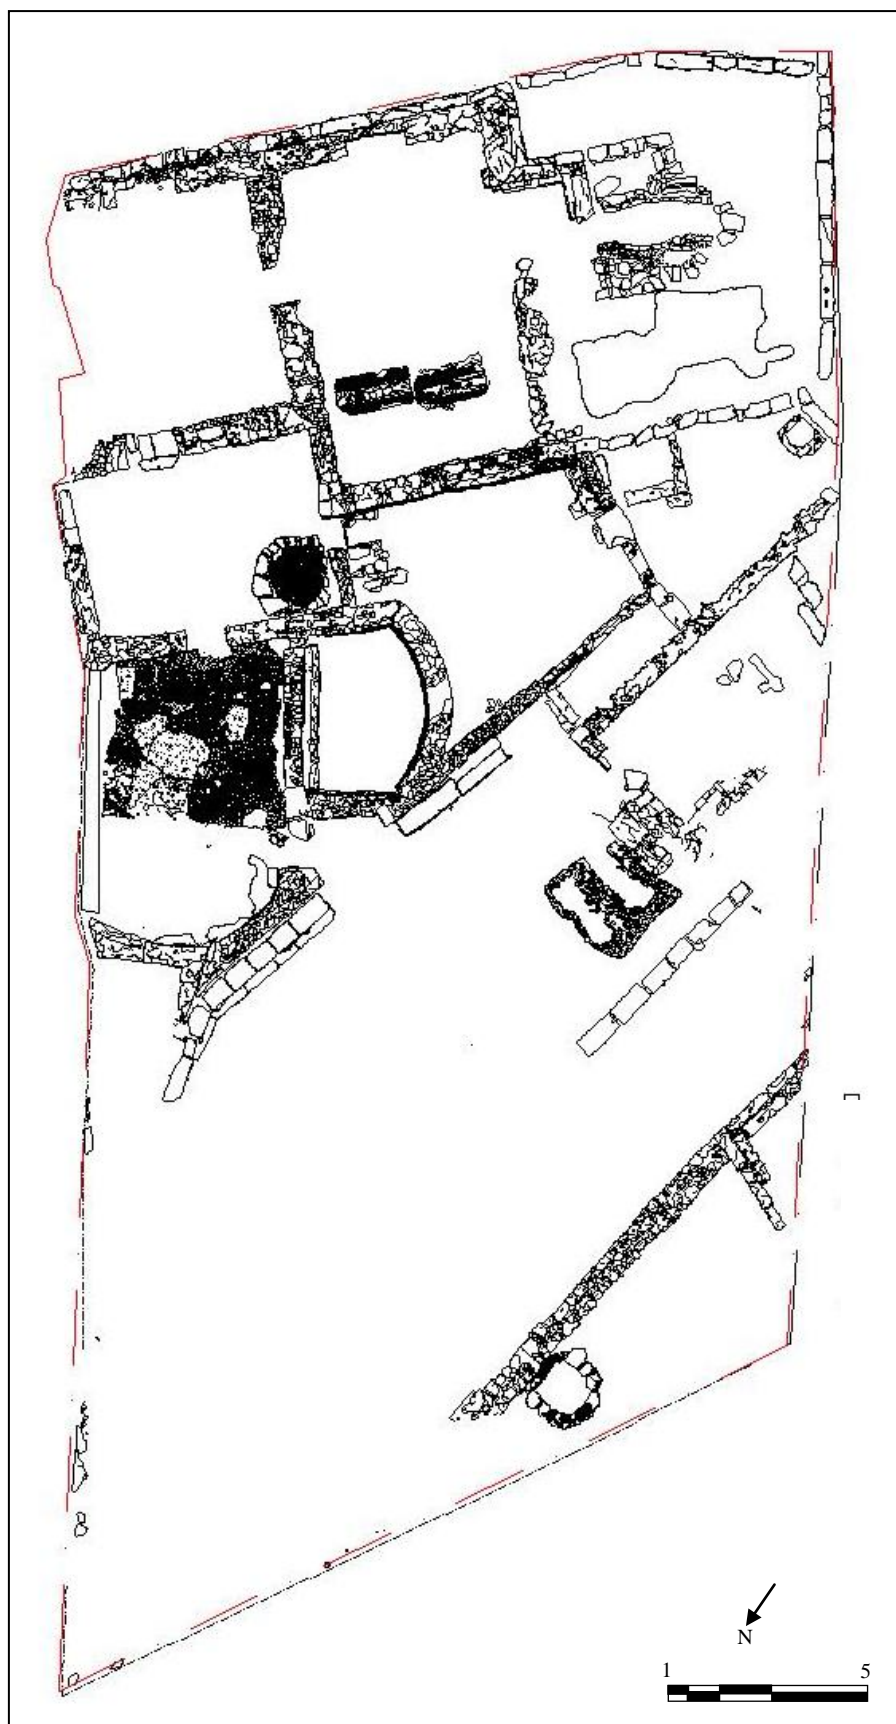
Planimetria ricavata a quota +0.80m con la caratterizzazione delle strutture.
